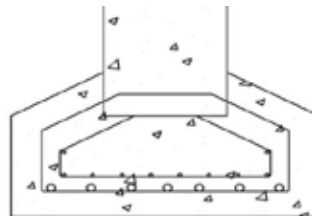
Detalle de disposición del acero de refuerzo en viga 1.
